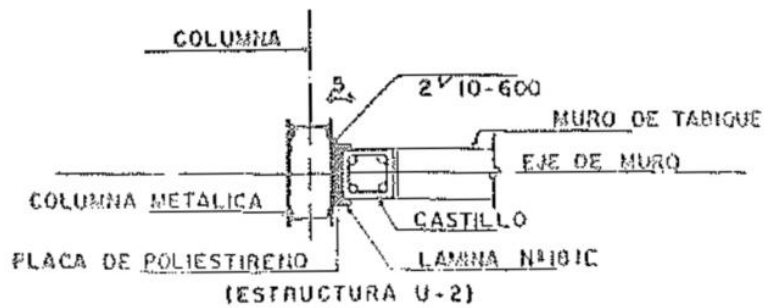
Detalles en unión muro-columna propuestos, pero no encontrado en sitio.
